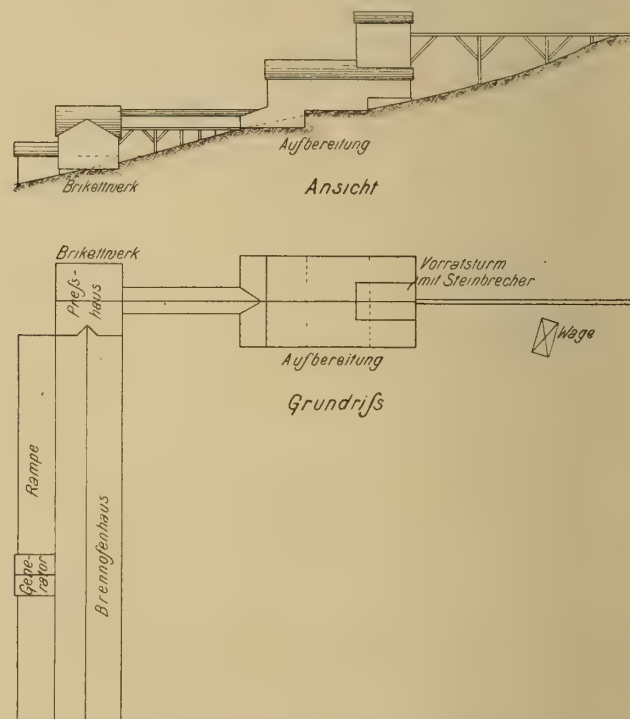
Seitenansicht und Grundriß der Aufbereitungs- und Brikettierungsanstalt zu Flogberget.
